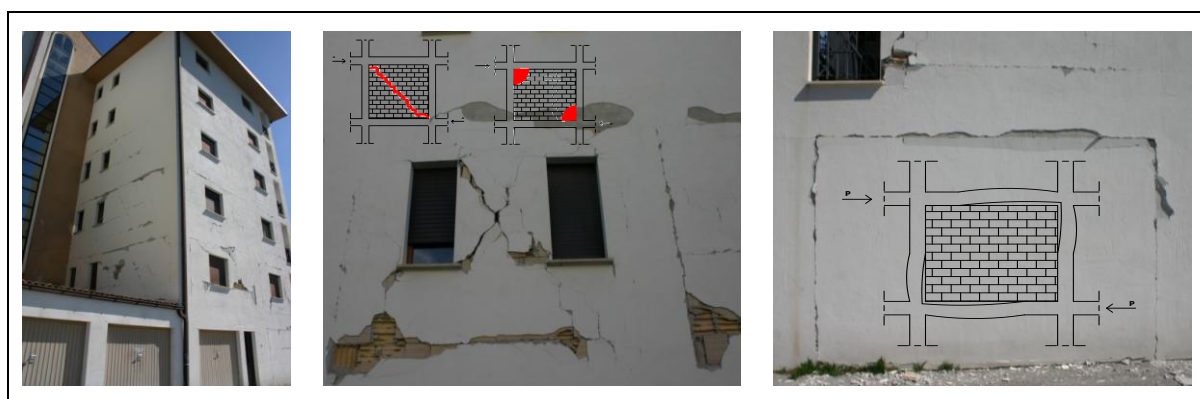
A fissuração generalizada resultante da resposta da parede no plano
